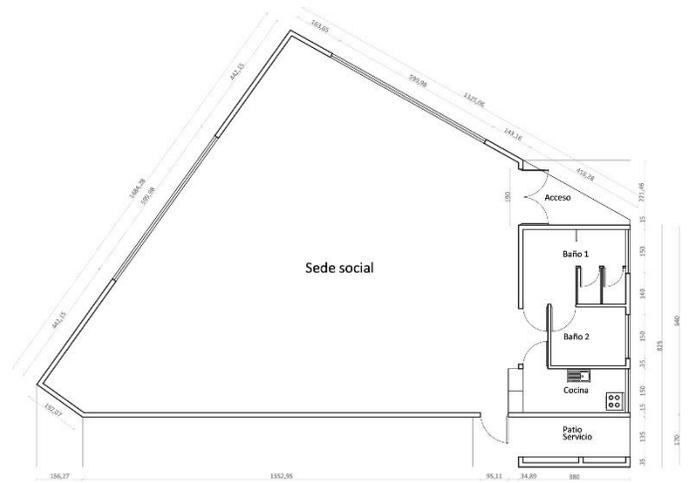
Planta esquemática sede social Villa Parque. Fuente: Elaboración propia
